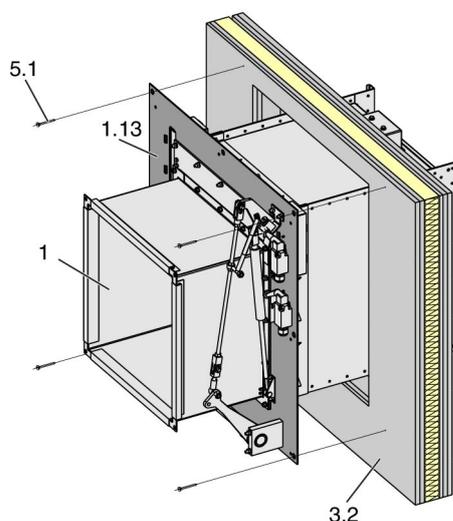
Einbau in Leichtbauwand (mit Schnellbauschrauben)
